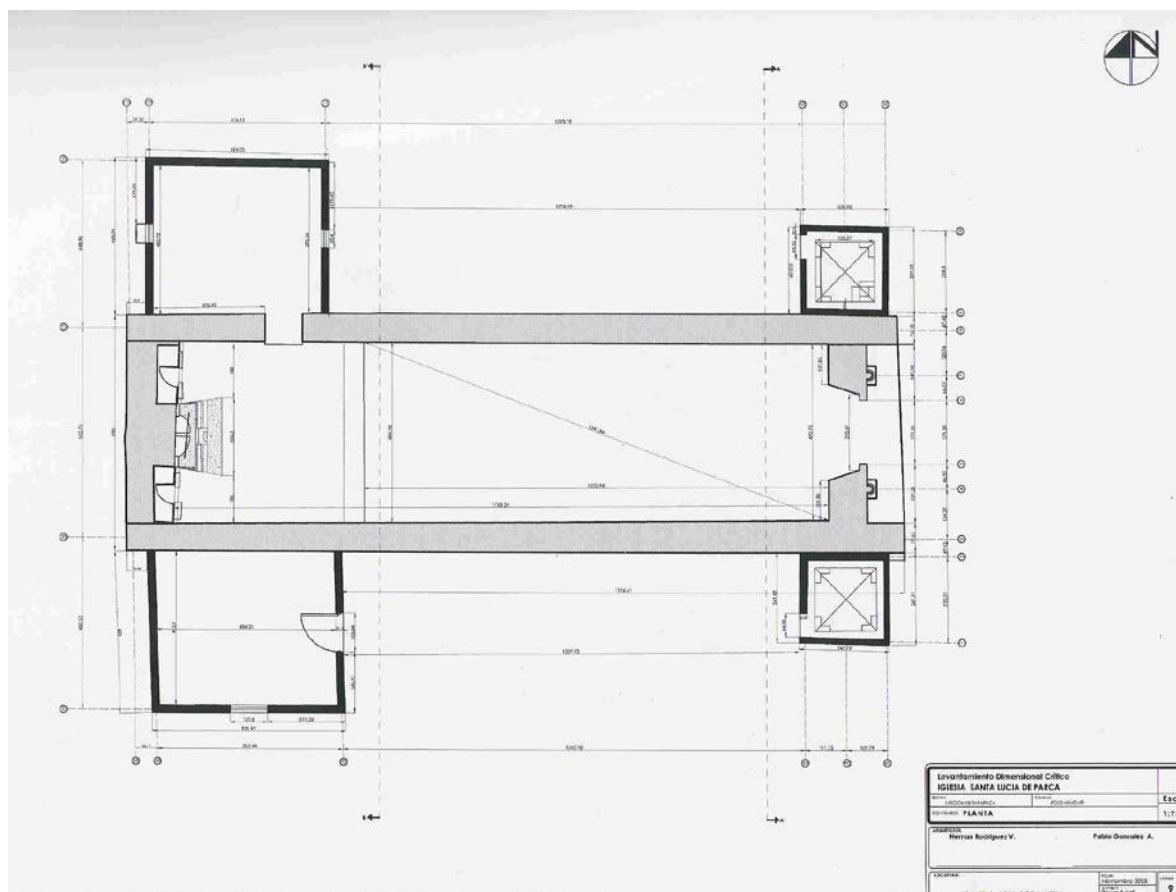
Planta de levantamiento de arquitectura. Arquitectos H. Rodríguez y P. González, 2005
